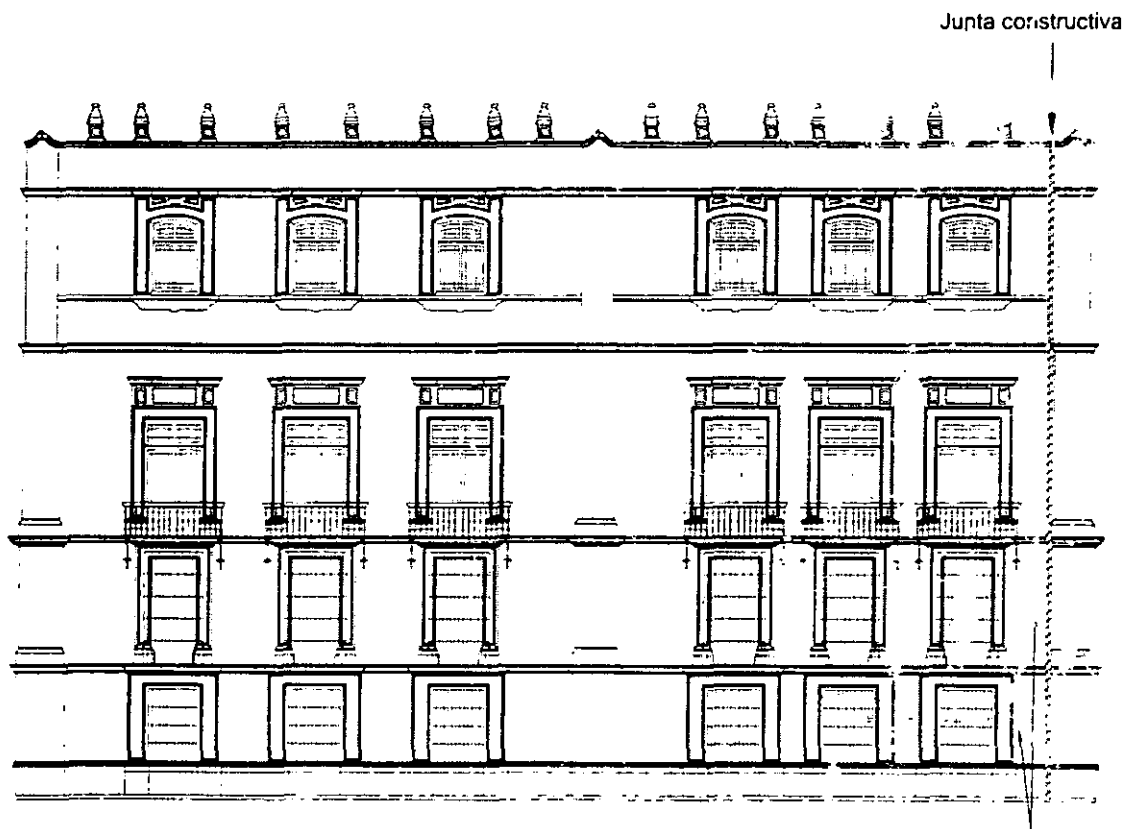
Ubicación de las juntas constructivas en la fachada norte del Palacio Nacional
